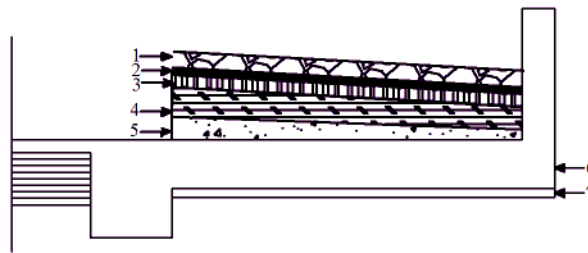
Coupe transversale du plancher terrasse inaccessible.
